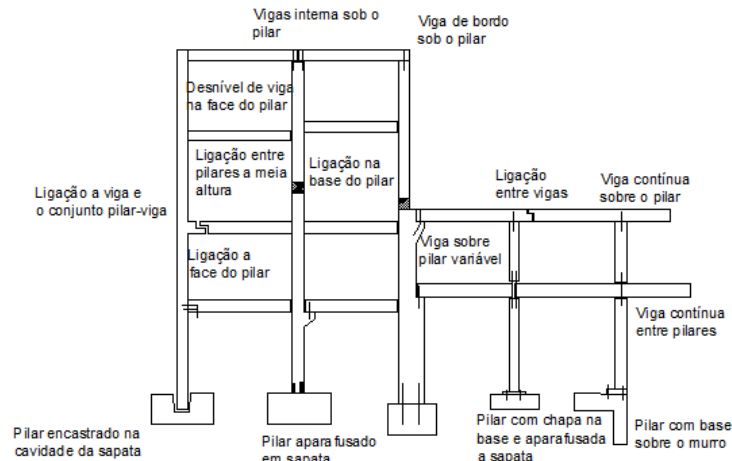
Ligações em estruturas reticuladas, adaptado de Elliot [9]
